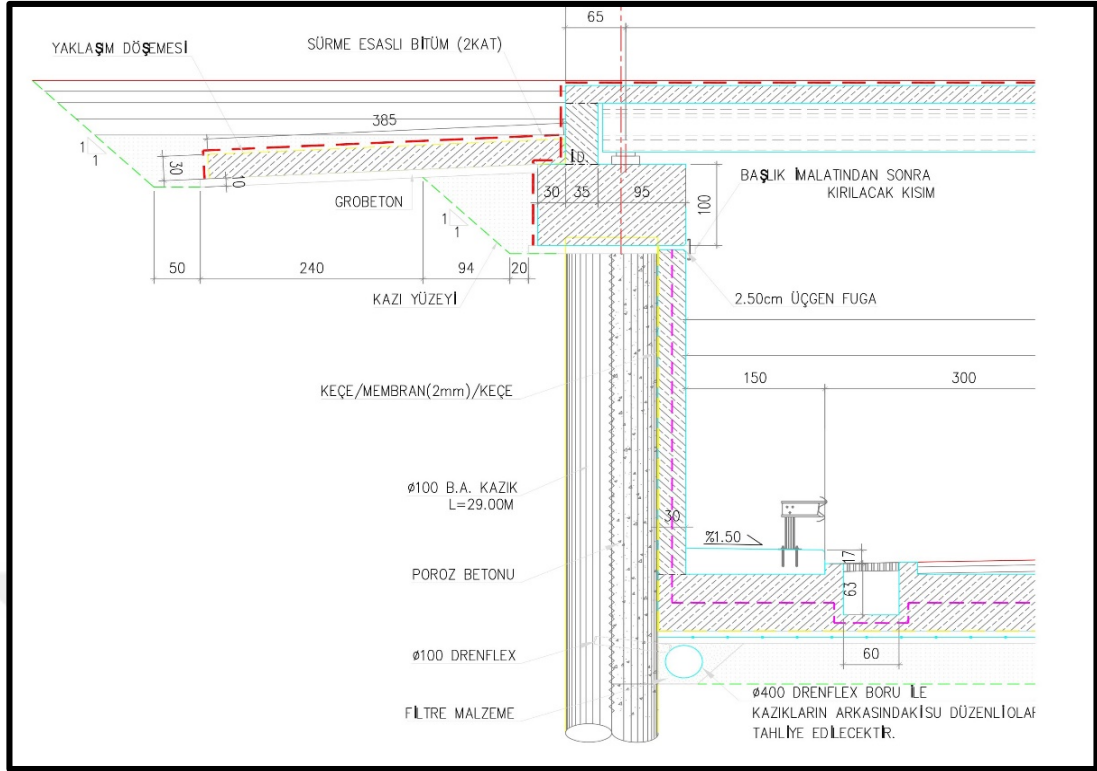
Fore kazık poroz beton drenaj kesiti
